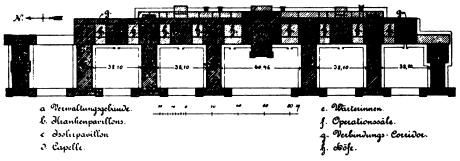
St. Thomas-Hospital in London. Lageplan.
